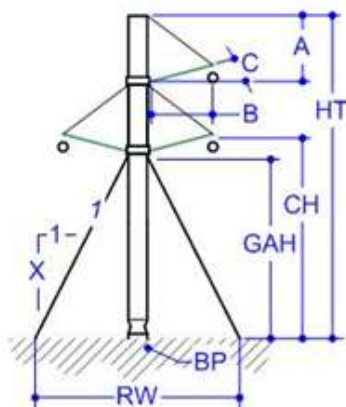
Perfil de la estructura tipo Delta a instalar.
